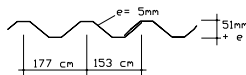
COBRIMENTO TRANSVERSAL: FIBROCIMENTO
